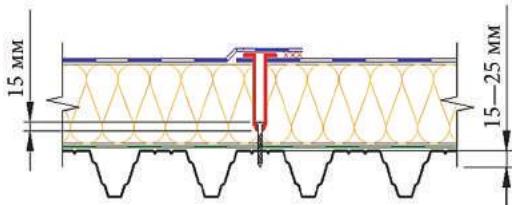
Механическое крепление кровельного покрытия по сжимаемому основанию
